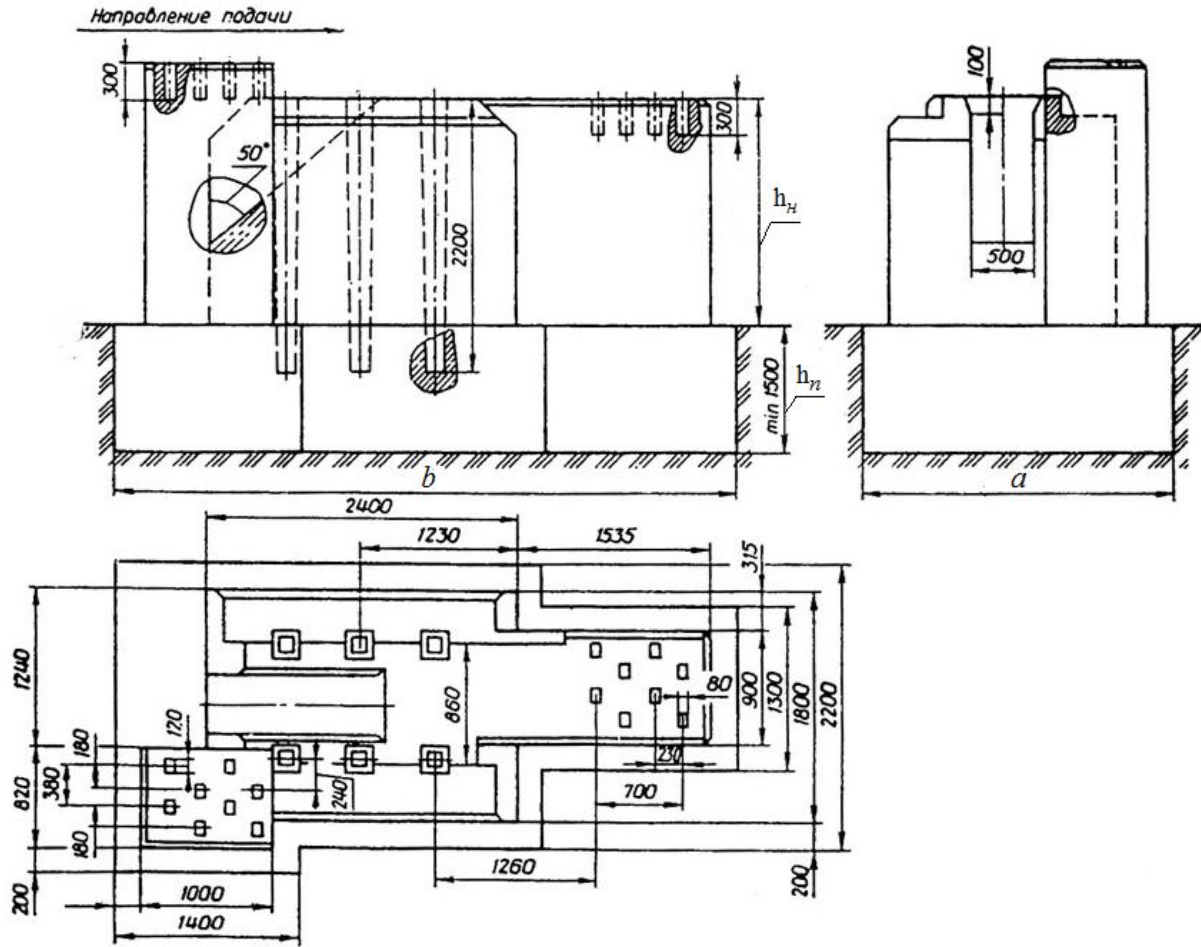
Фундамент одноэтажной лесопильной рамы Р63-4
